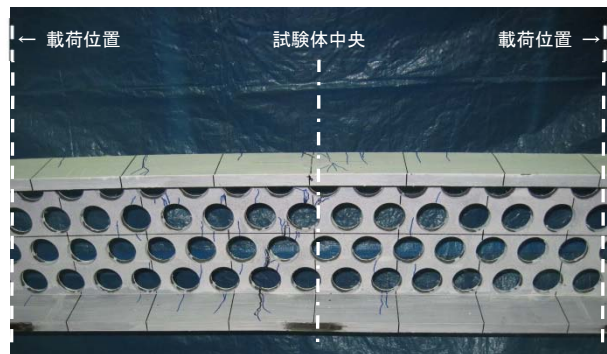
載荷実験におけるひび割れ状況 (B 方向載荷)
